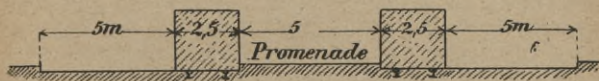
Straßenbahnführung in breiter Straße mit Mittelpromenade.
